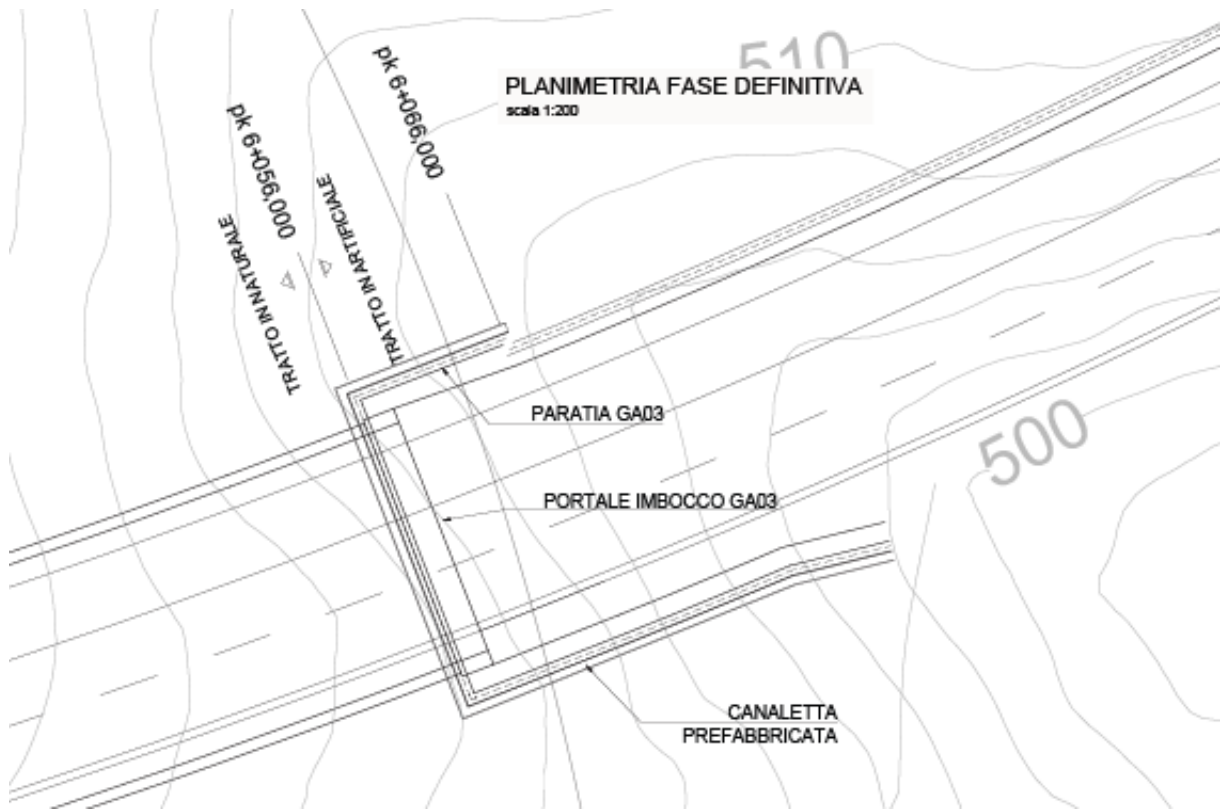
GA03 - Stralcio di planimetria della paratia d'imbocco
